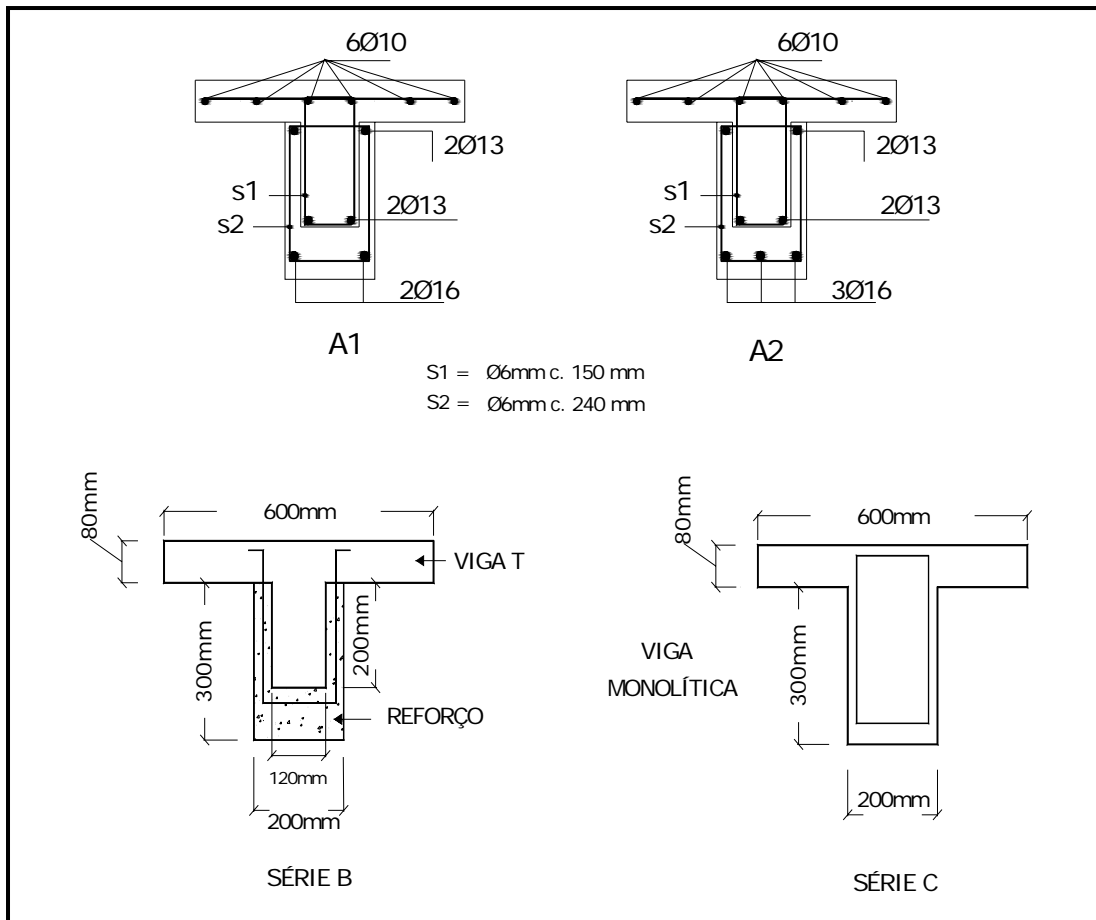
Detalhes das vigas ensaiadas por LIEW e CHEONG (1991).
